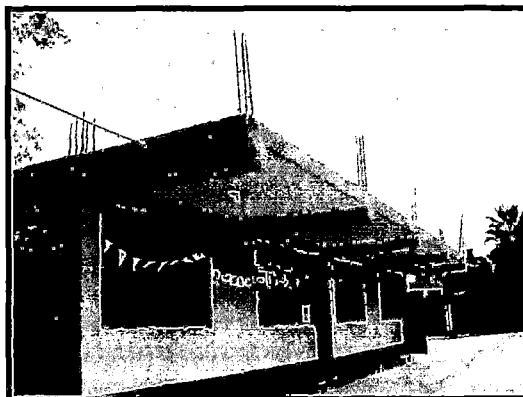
GUE Maria Parado de Bellido, se aprecia una estructuración tipo B.
